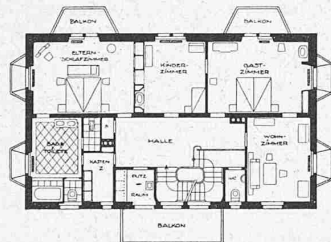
bis 4 Grundrisse, Abb. 5 Schnitt zur Villa Arbenz. — 1 : 400.
